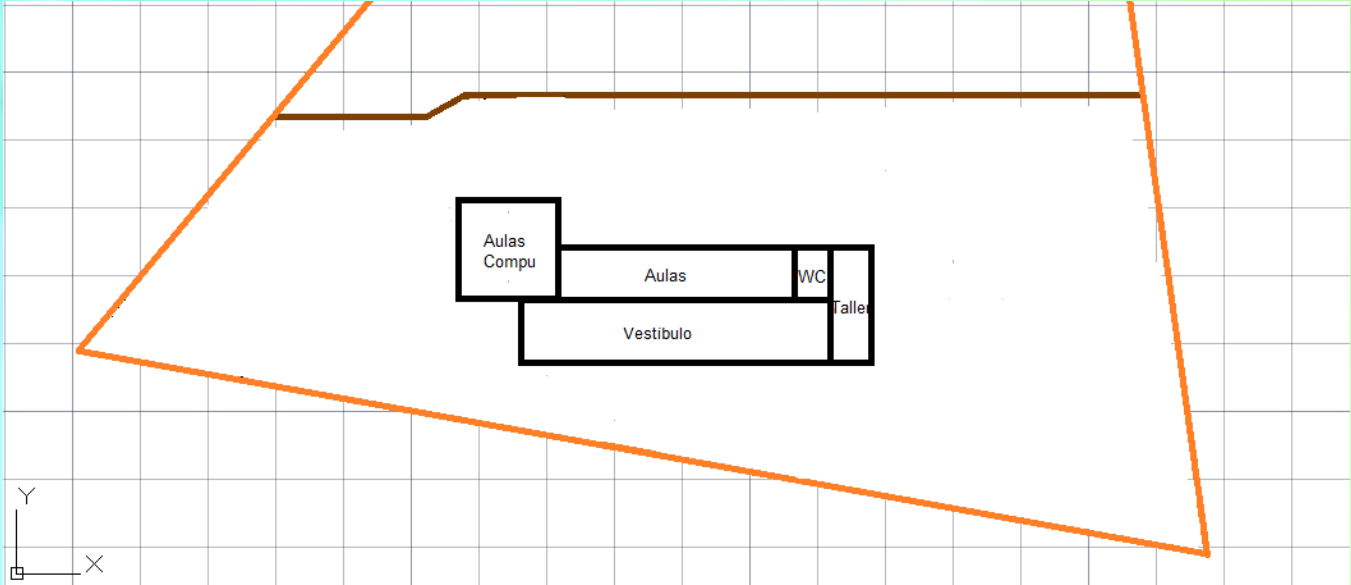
, Zonificación Segunda Planta, Foto EDGM
